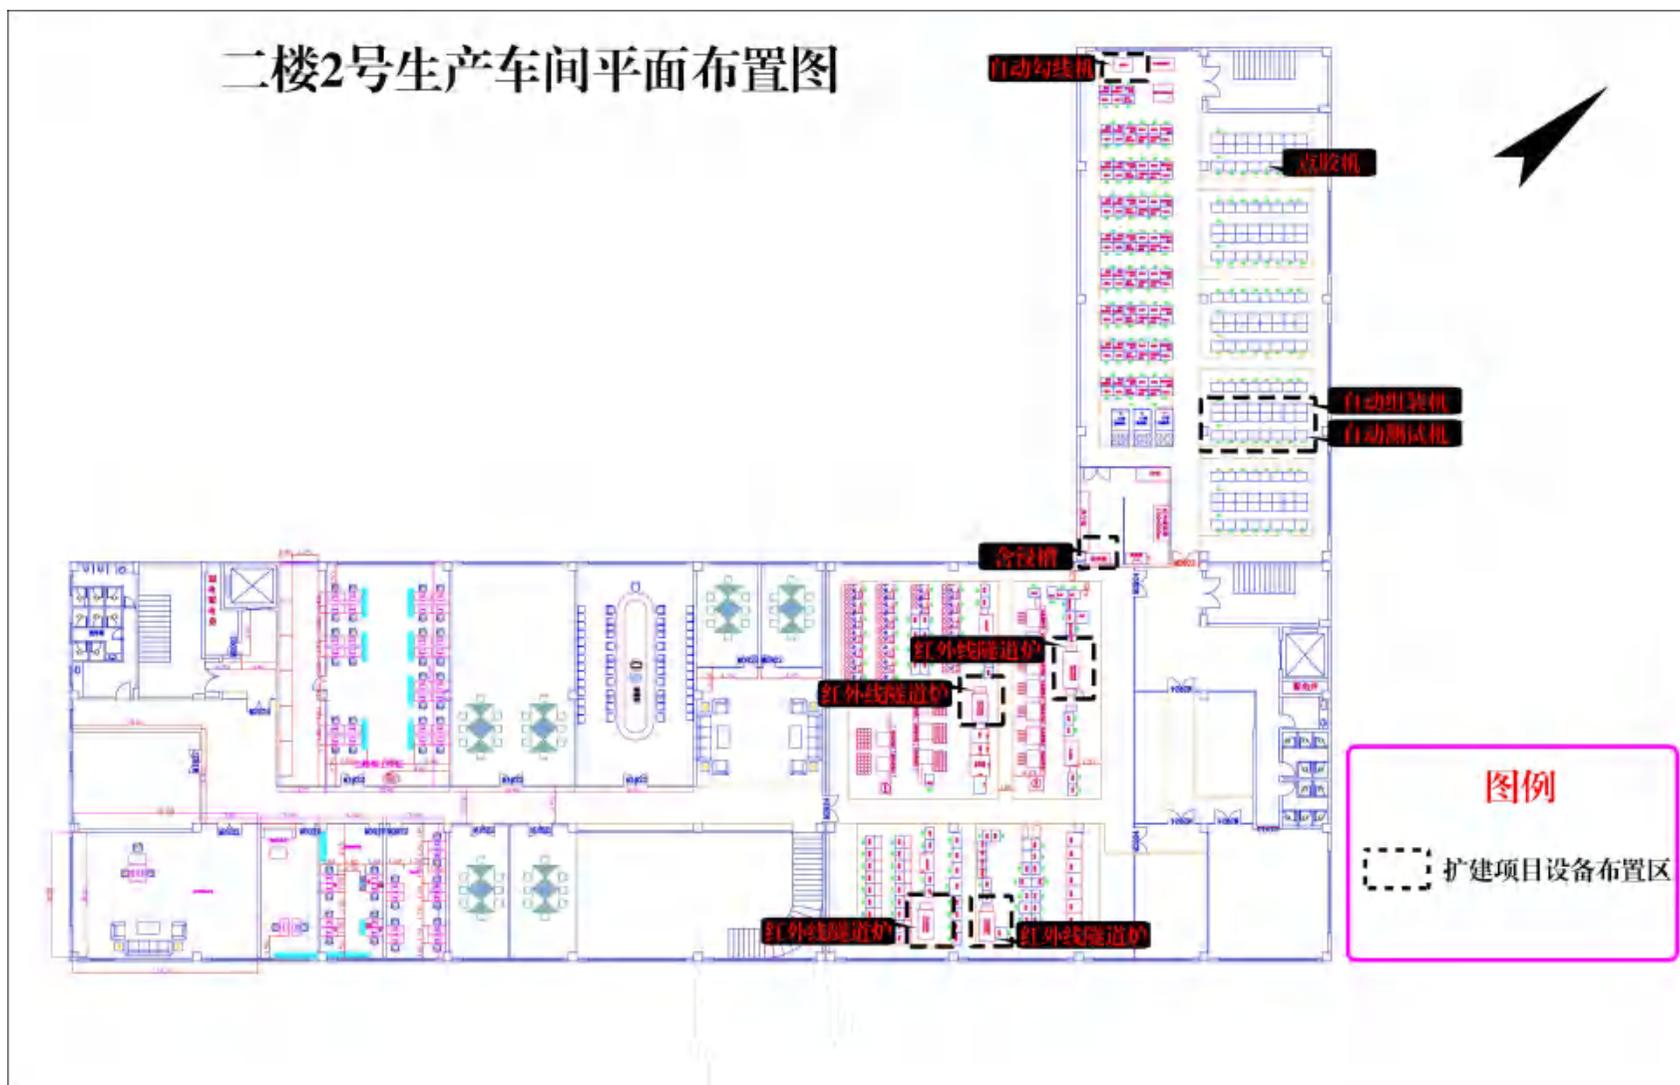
项目生产车间平面布置图（二楼 2 号生产车间）
